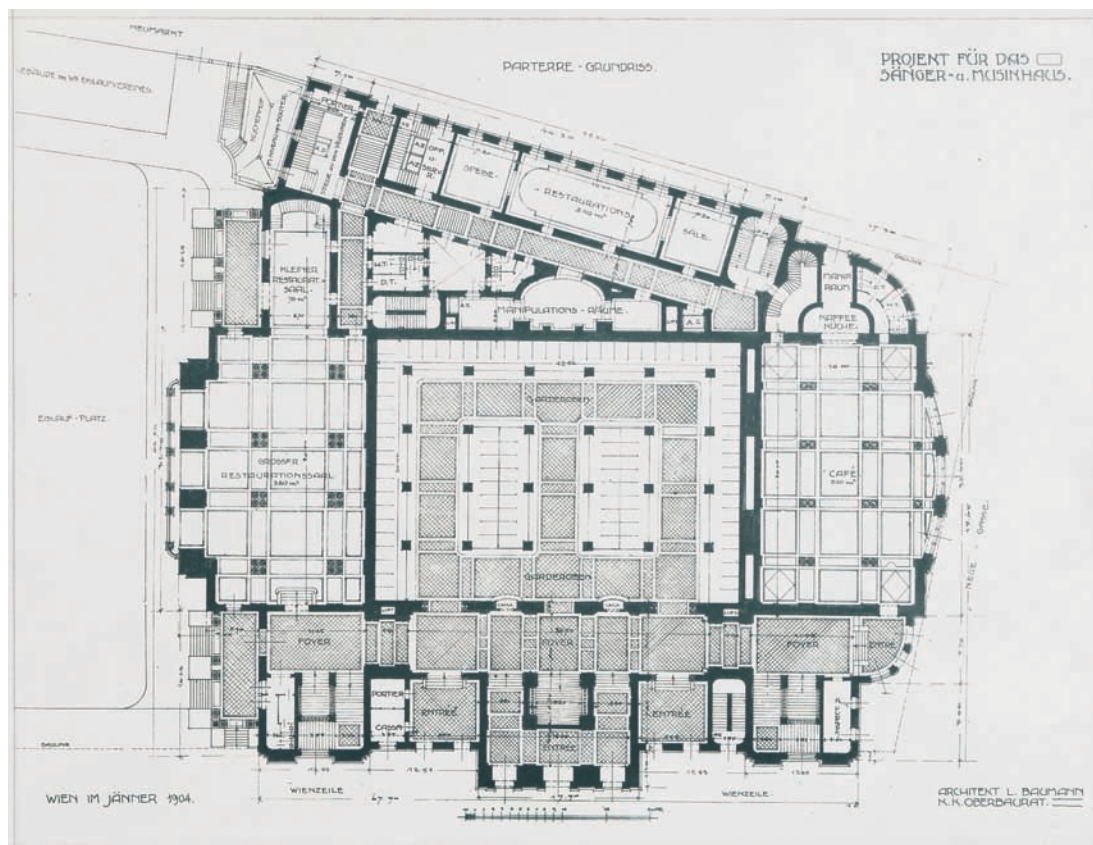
Ludwig Baumann, Projekt eines Musik- und Sängershauses, 1904, Erdgeschoßgrundriss (Wien Museum, Inv.-Nr. 238.049/13).
